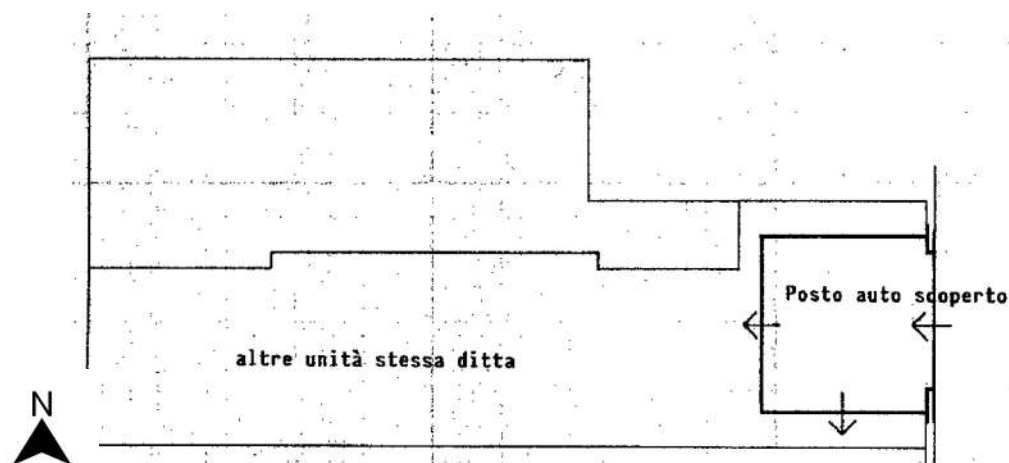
Planimetria catastale P.lla 953 sub. 2 – stato approvato
